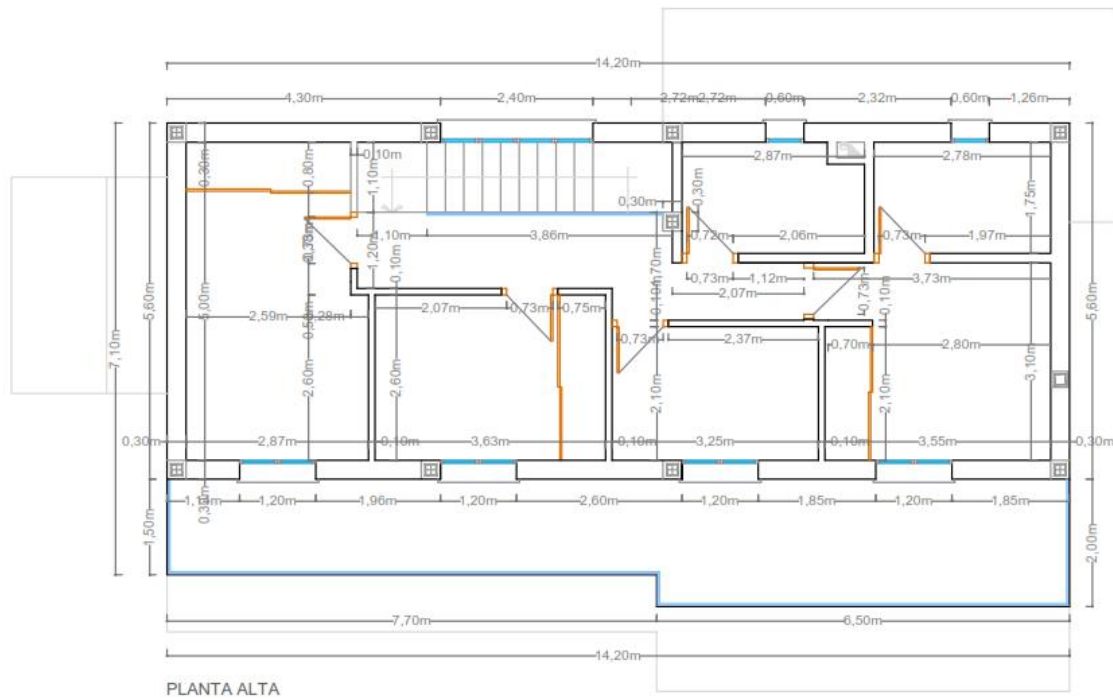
Plano acotado de la planta alta del inmueble objeto.
